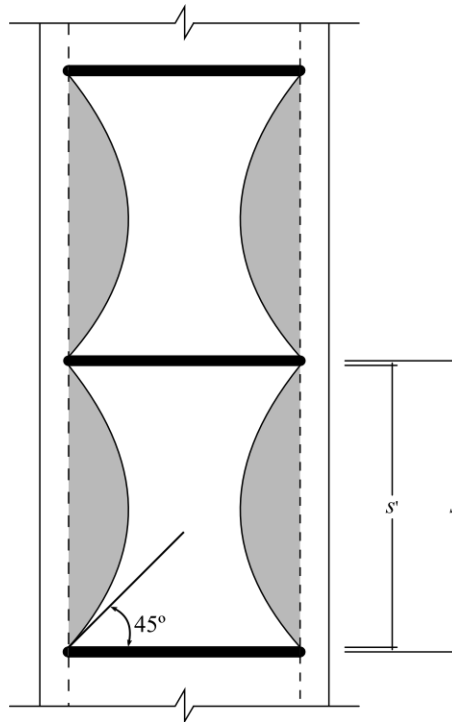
Efeito de parábola no confinamento do betão entre as armaduras transversais (adaptado de [44])
